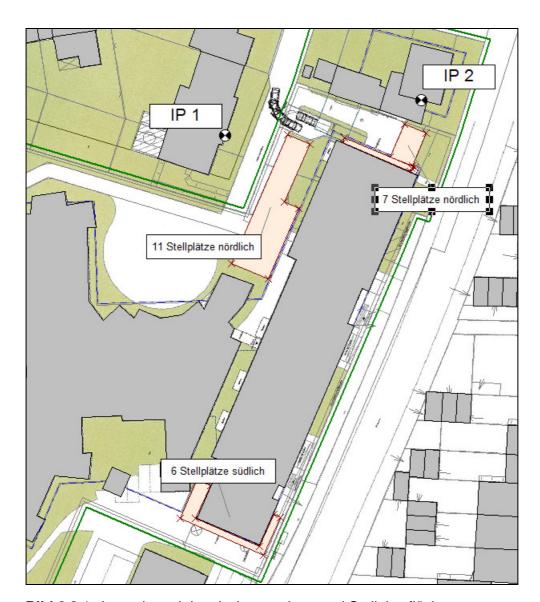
Lageplan mit Immissionspunkten und Stellplatzflächen
